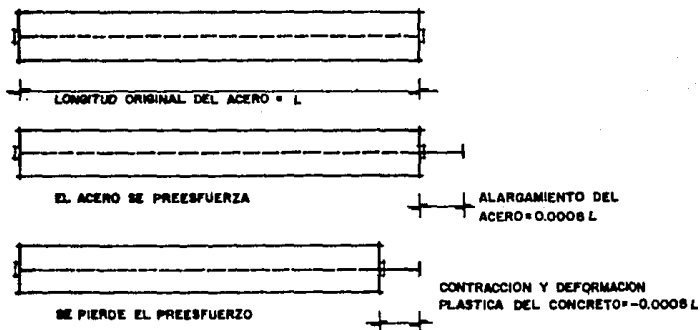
PREESFUERZO DEL CONCRETO CON ACERO ESTRUCTURAL, ORDINARIO.
